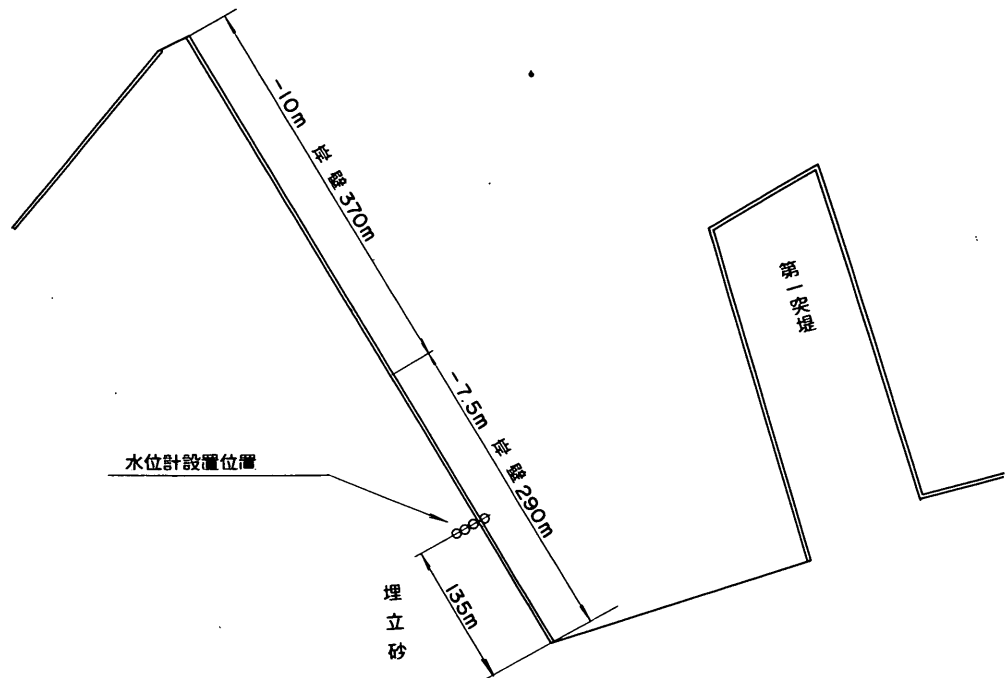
下関港(細江地区)平面図および-7.5M岸壁断面図
